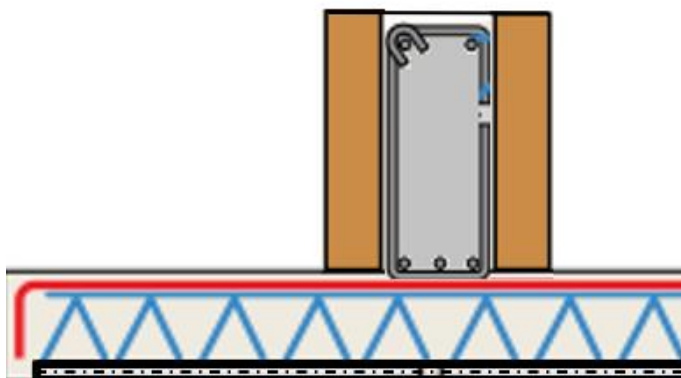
elemento estrutural de vigamento invertido - vista inferior
